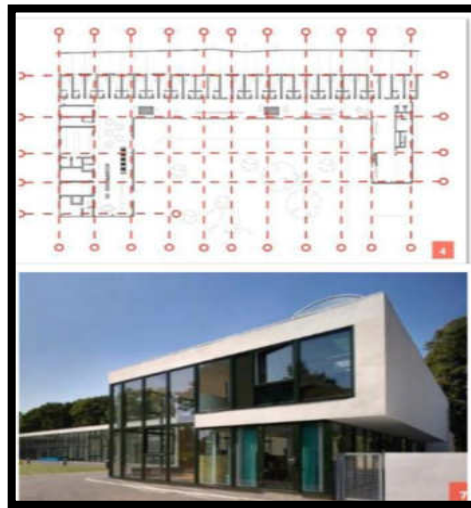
sistema constructivo (centro de Spring Garden – Inglaterra) fuente:
